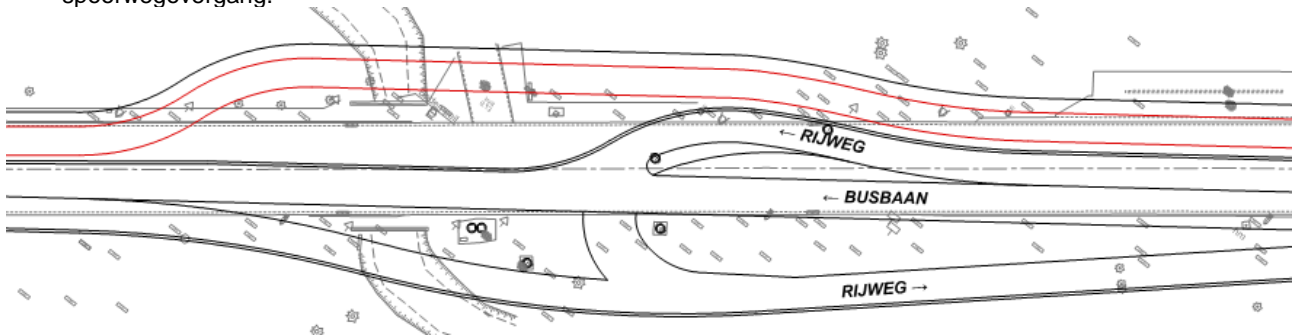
Uitsnede uit PRUP stationsomgeving Haacht
